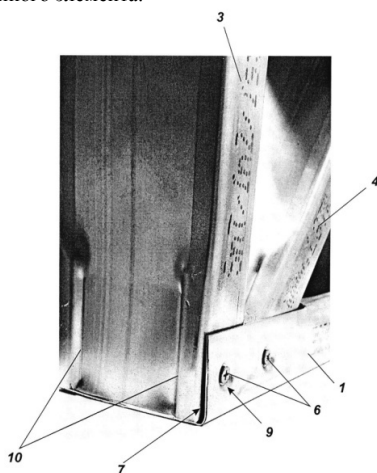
Фрагмент пространственной каркасной конструкции и узел соединения тонкостенных элементов этой конструкции [11], где: 1 - нижний пояс; 3 – стойки; 4 – раскосы; 6 – саморезы; 7 – клеящий слой; 8 – усиливающая пластина; 9 – коническое углубление; 10 – соединяемый конец.
